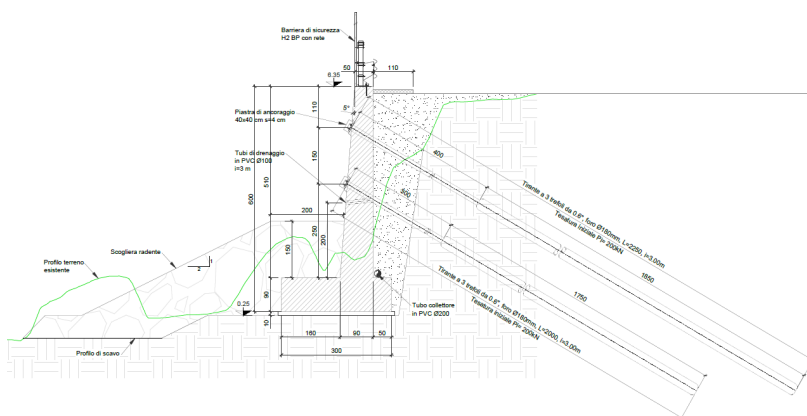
Elab. A-I-24-5 Intervento 24 Pianta e sezioni di progetto
